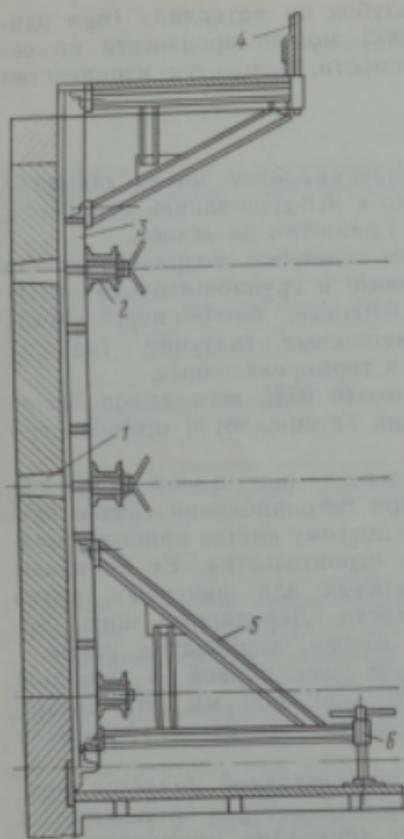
Щитовая модульная опалубка стен ЦНИИОМТП:
